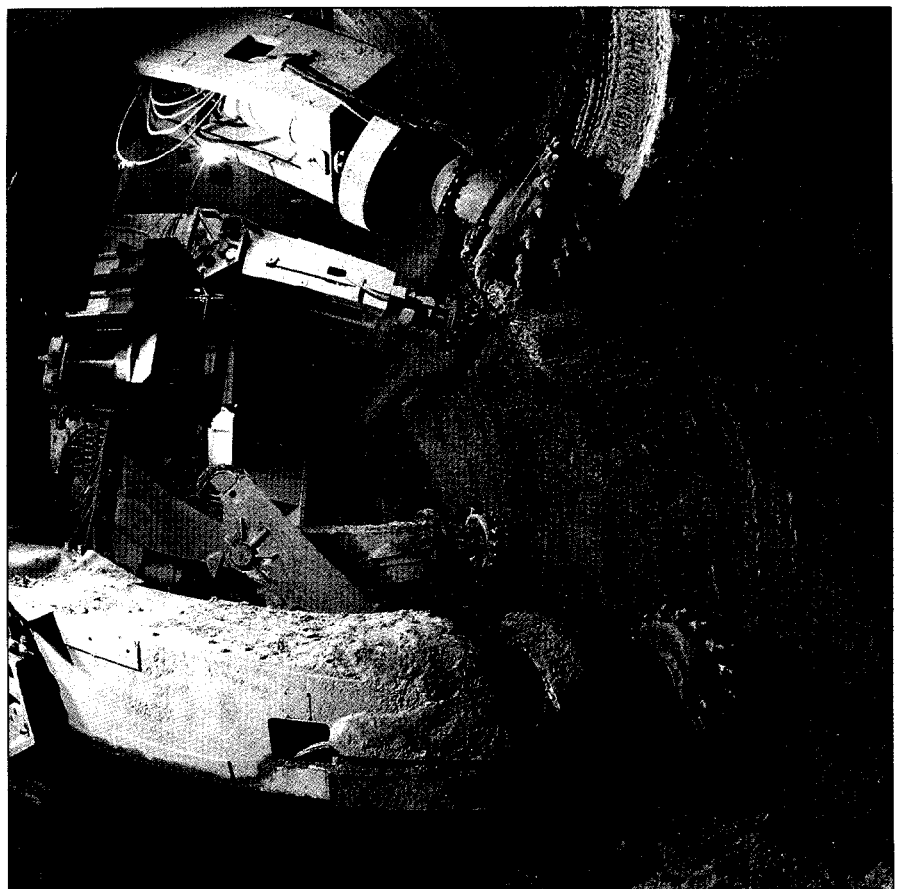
Mit Rundschaftmeißeln bestückte Werkzeugköpfe von Teilschnittmaschinen
